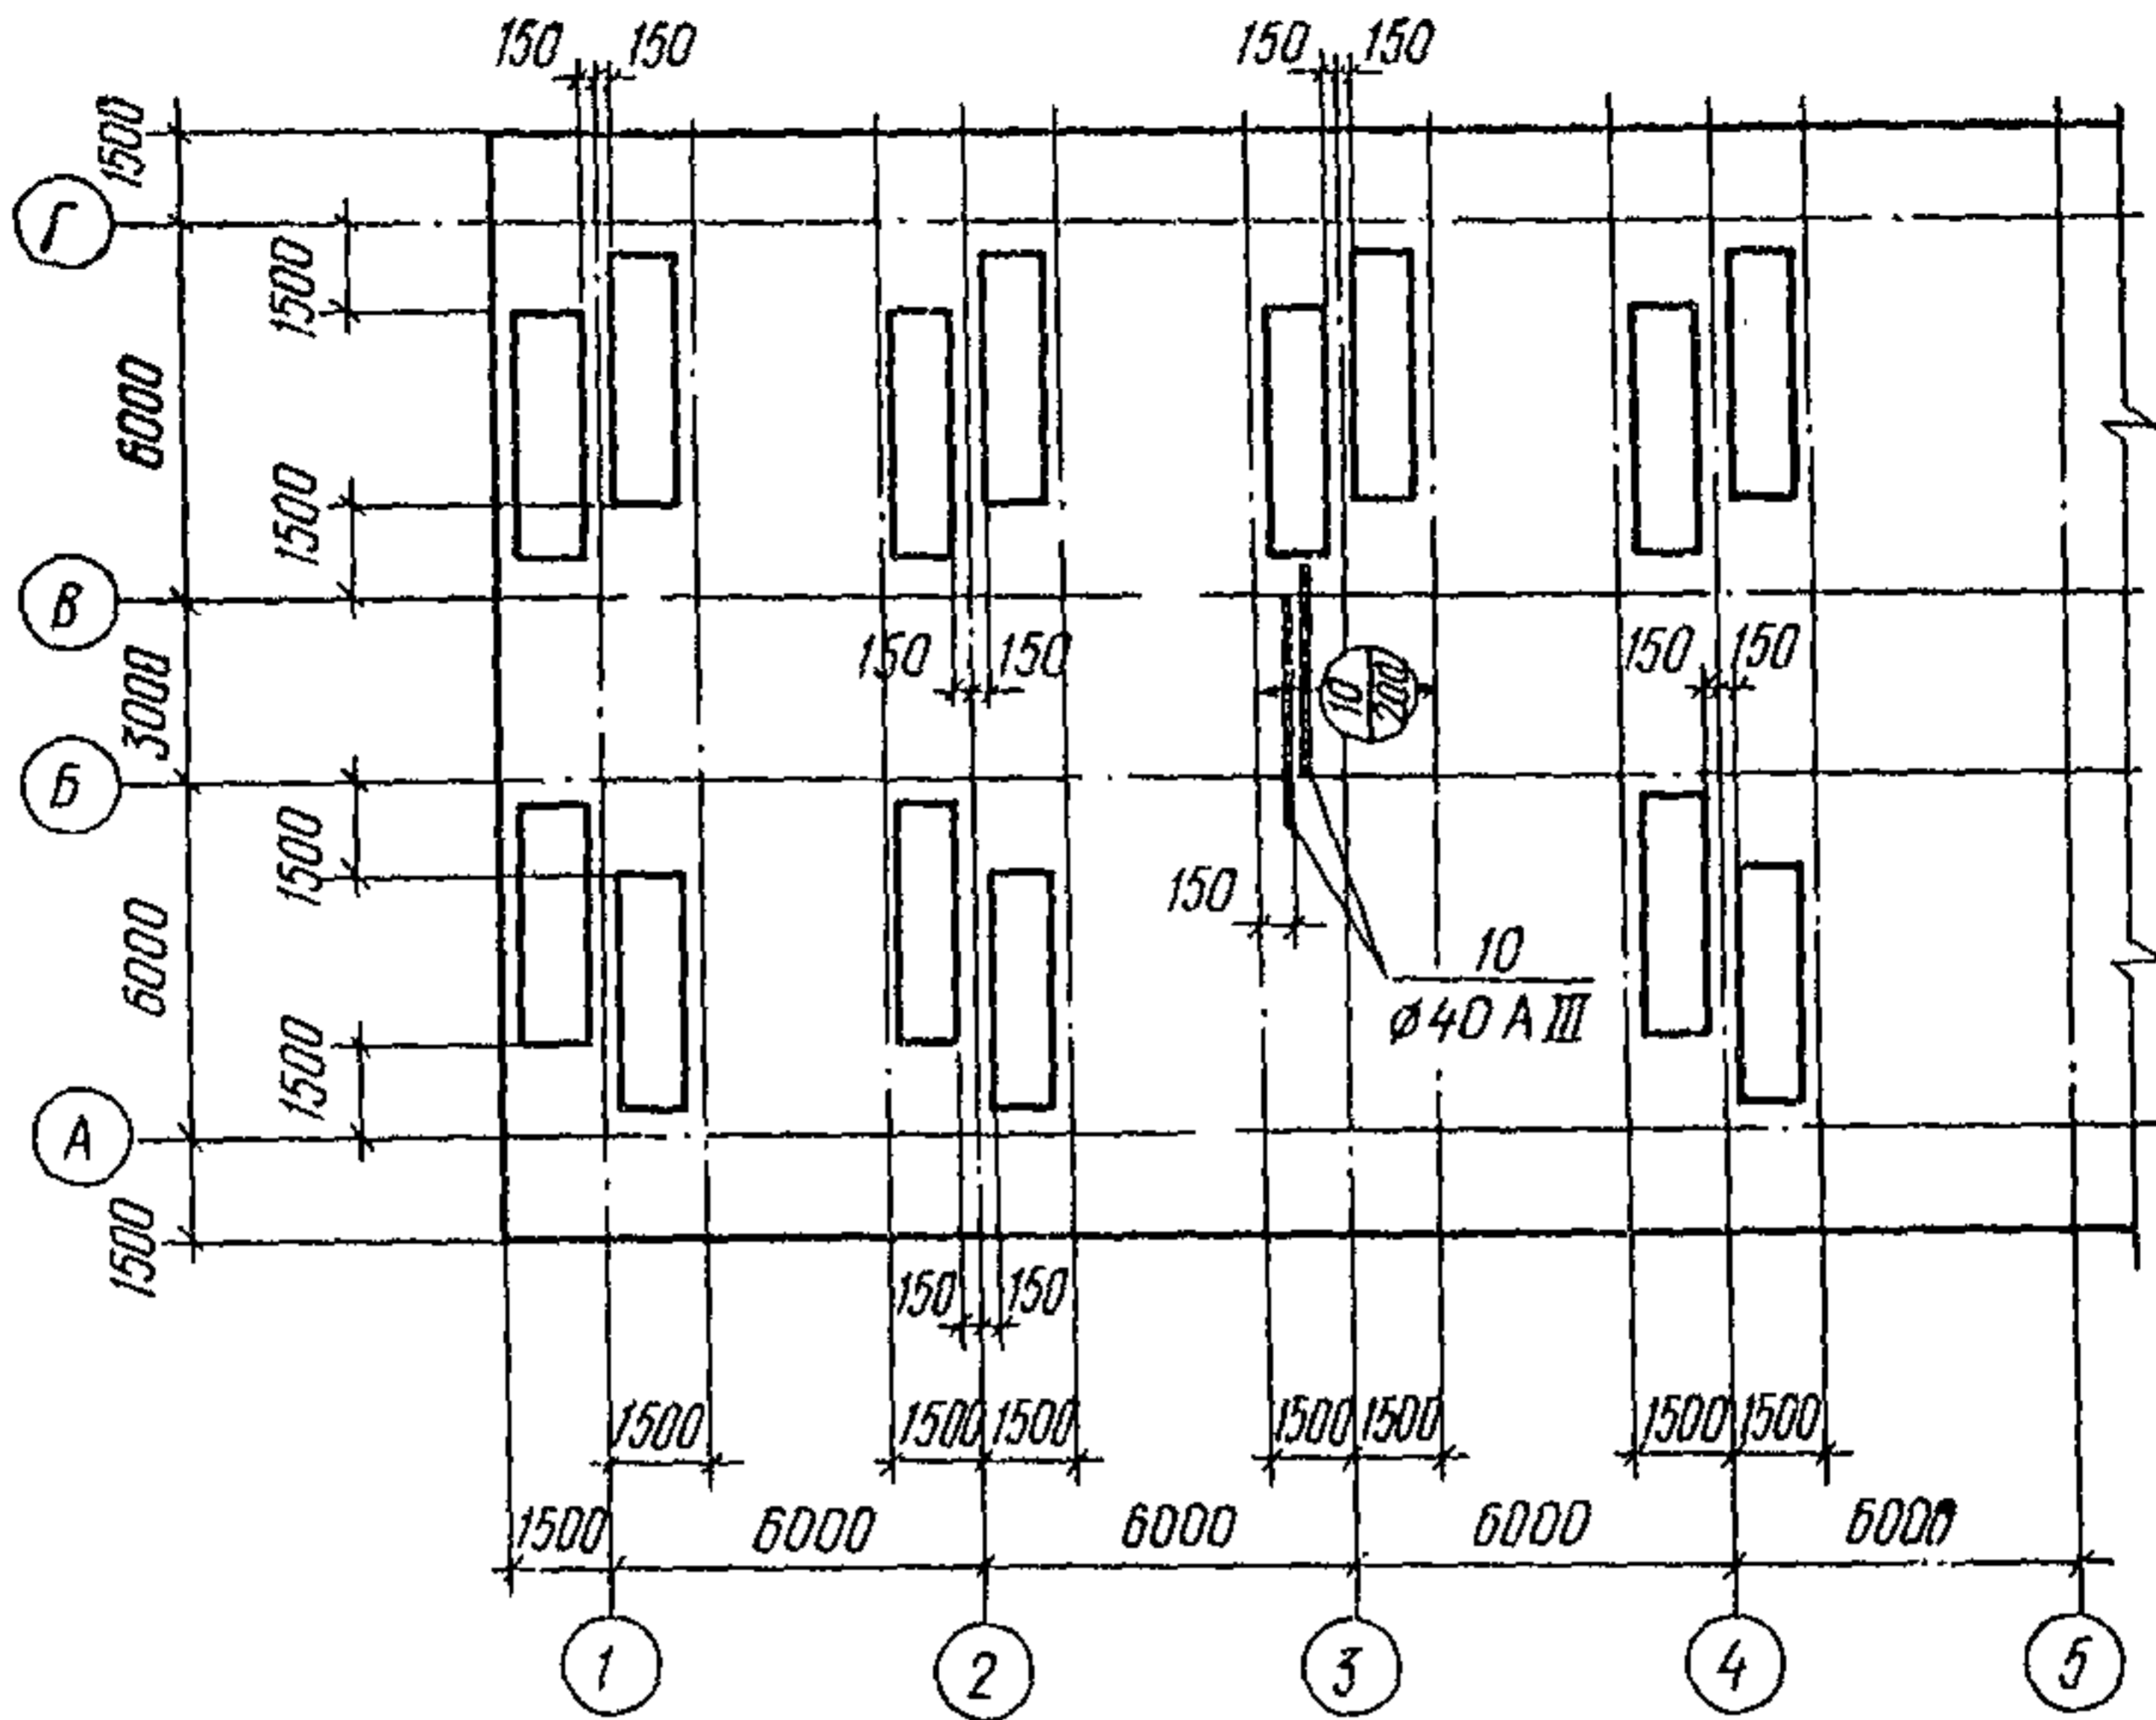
План раскладки унифицированных сеток и арматуры второго слоя верхней зоны (верхние сетки)
